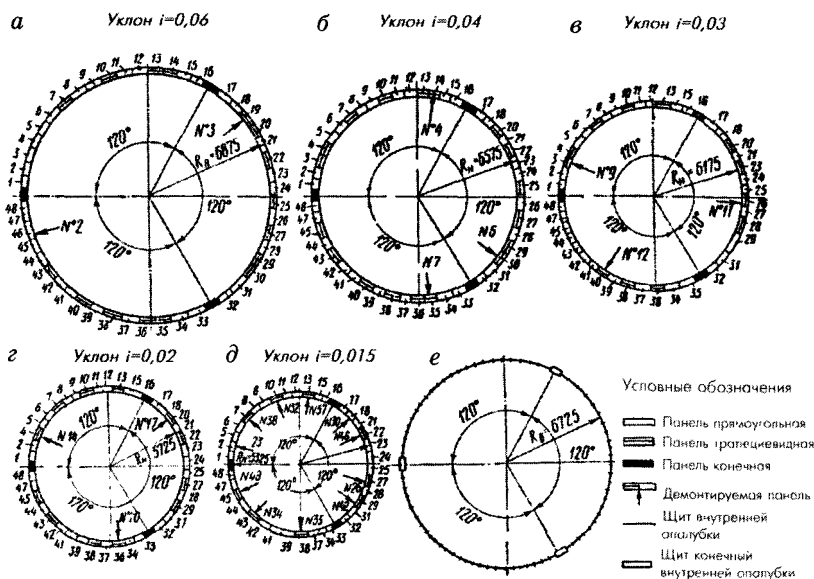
Монтажные схемы наружной и внутренней опалубки для возведения ствола трубы высотой 150 м и выходным диаметром 7 м на отметках:
